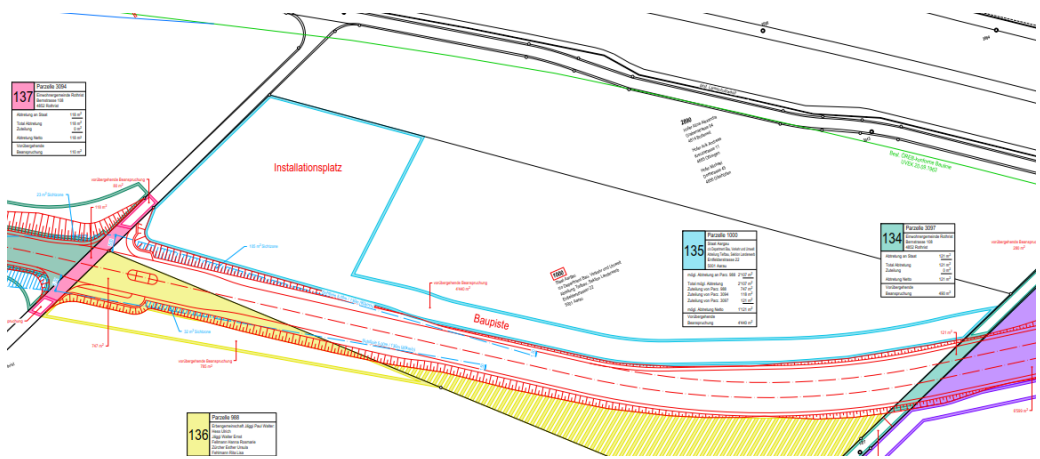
Ausschnitt aus dem Landerwerbsplan: Installationsplatz und Baupisten entlang der neuen Strasse.⁹²
